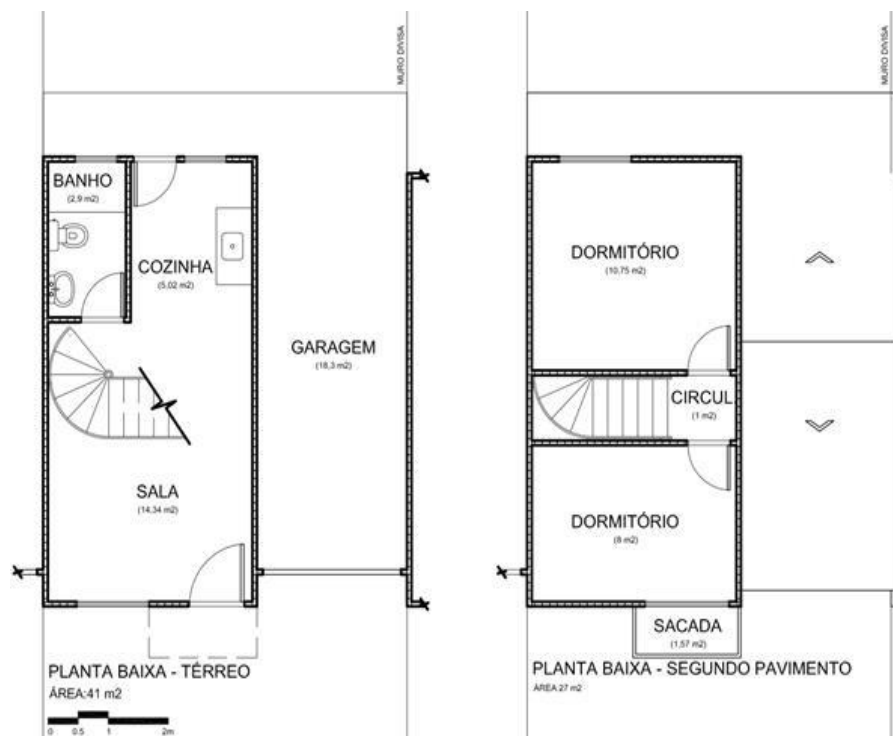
Planta Baixa esquemática: sobrado Parque Residencial São Pedro
